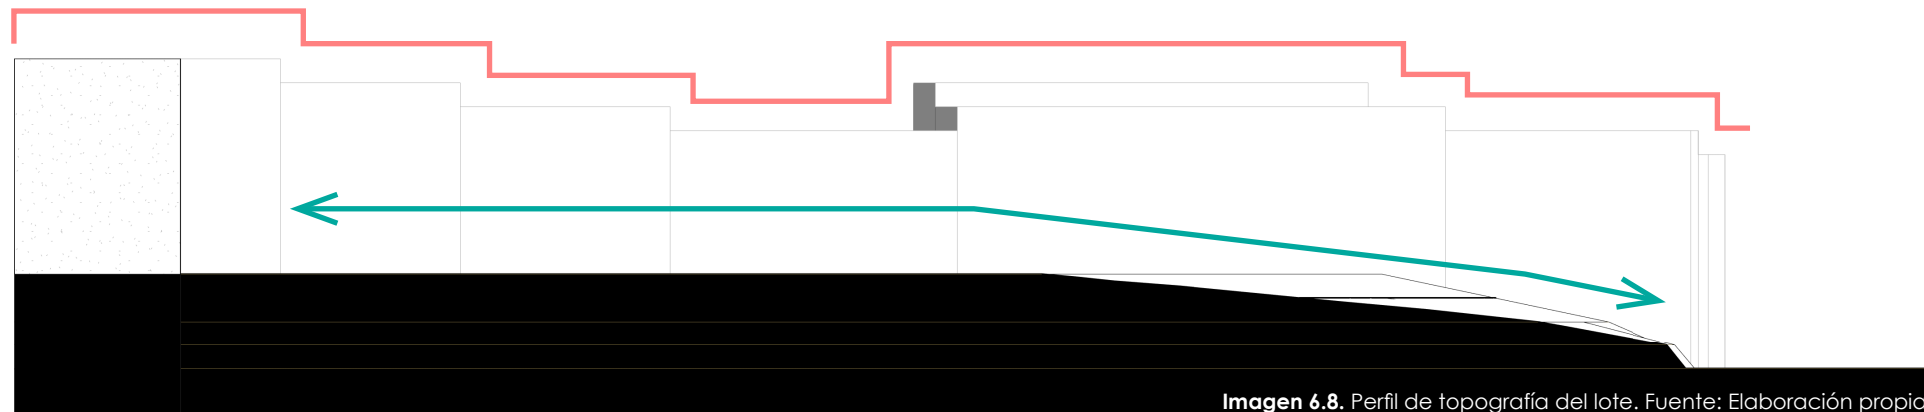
Perfil de topografía del lote. Fuente: Elaboración propia.
